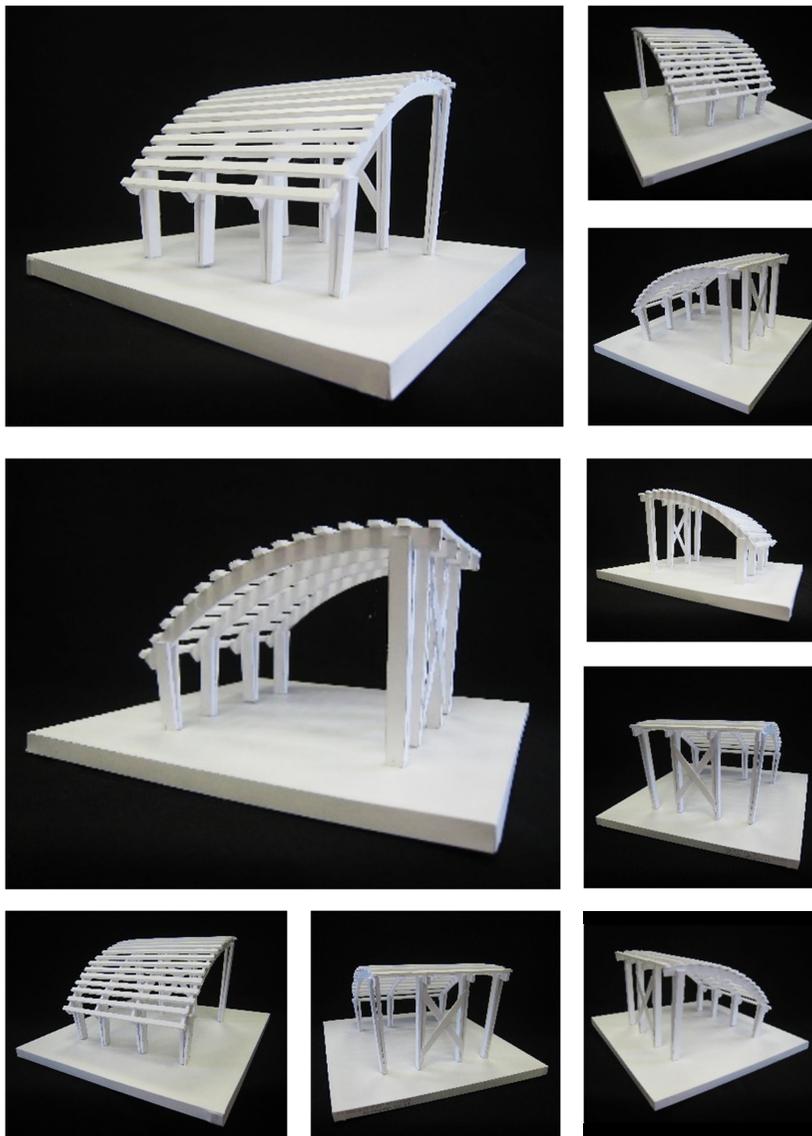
Теневой навес-беседка из клееных деревянных конструкций.
